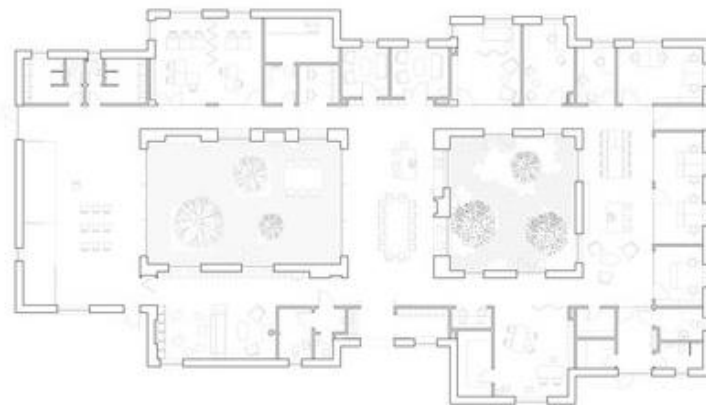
21 Livsrums Cancer Counselling Centre Site Plan
